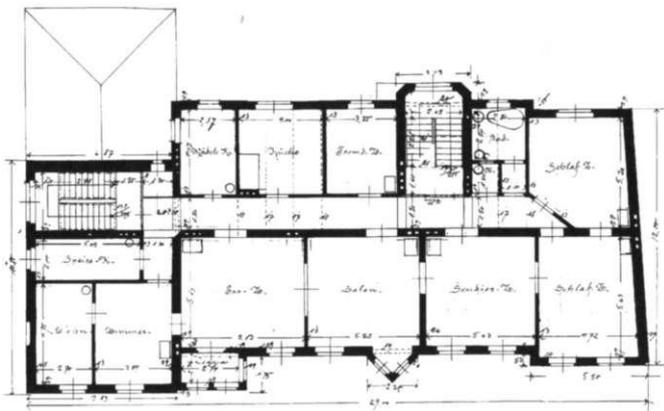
Goethestraße 28, Grundriß 1. Obergeschoß
